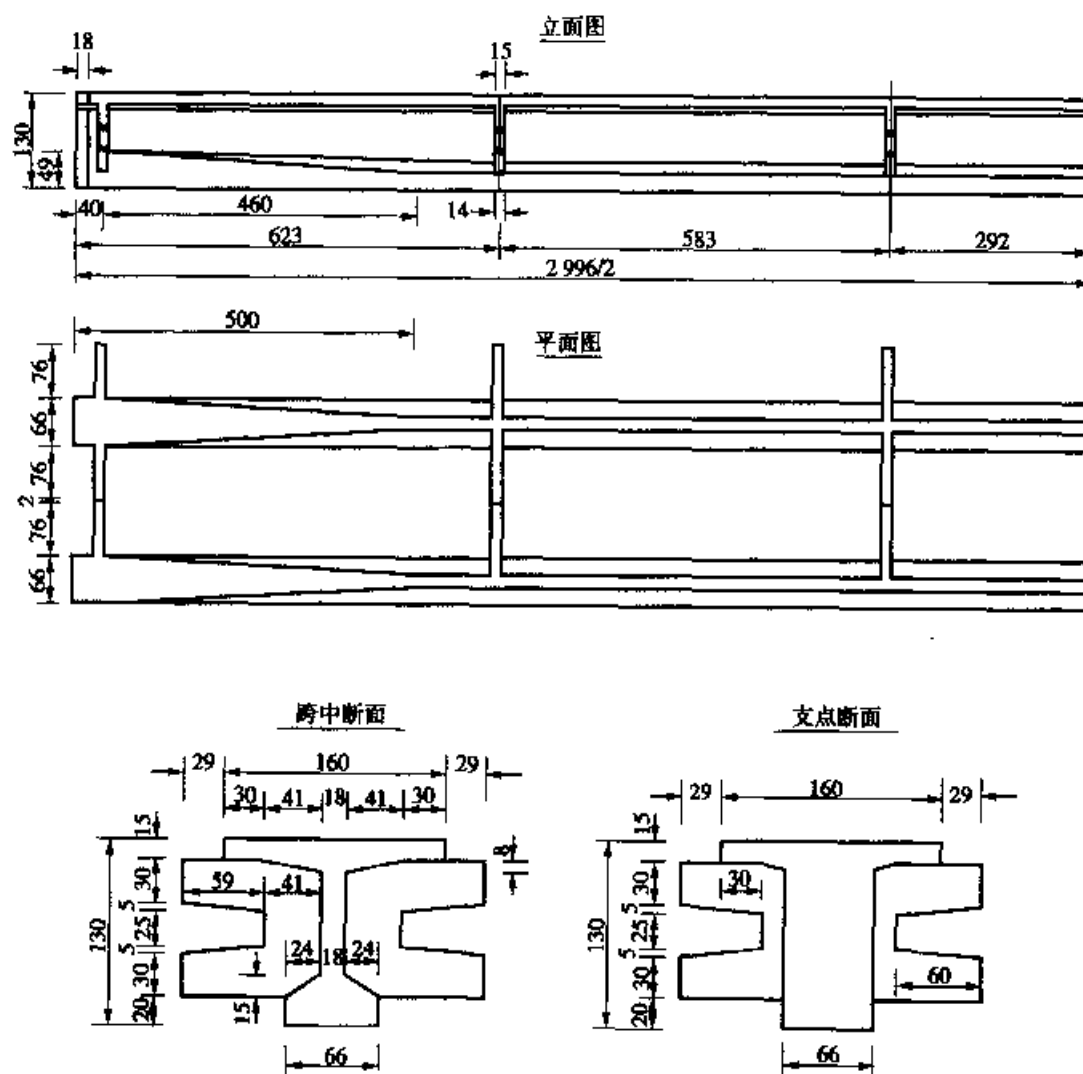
桥梁横断面尺寸(尺寸单位:cm)
